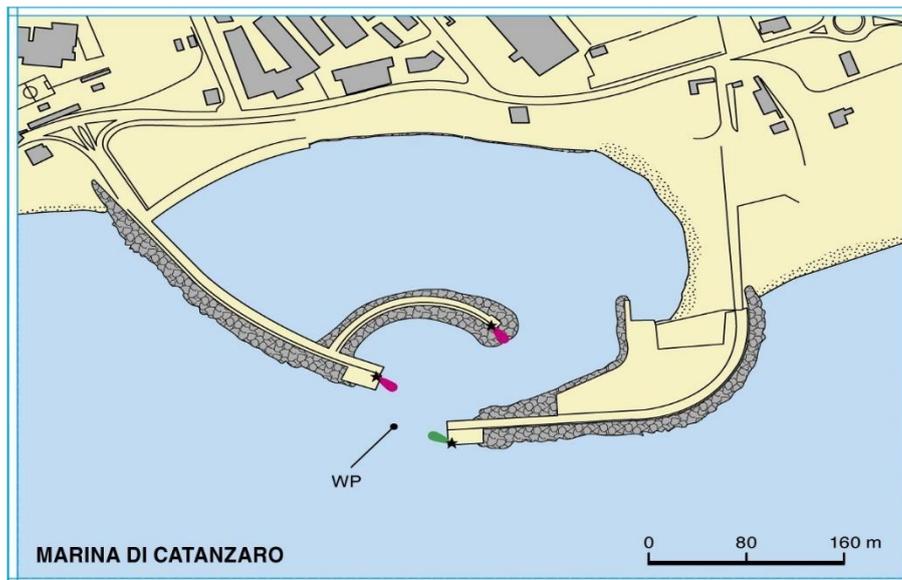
Planimetria dell'area portuale nello stato attuale
